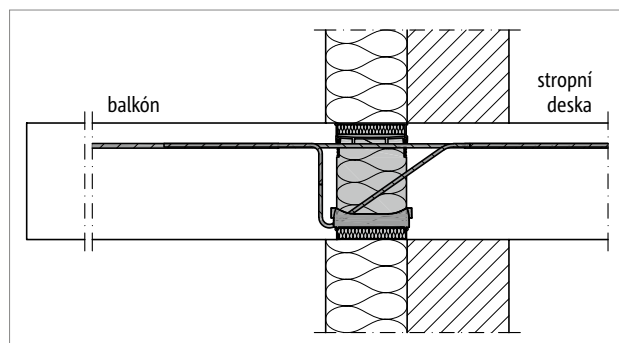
Schöck Isokorb® XT typ KL: Balkón na zalomené fasádě (otevřený ze dvou stran)
